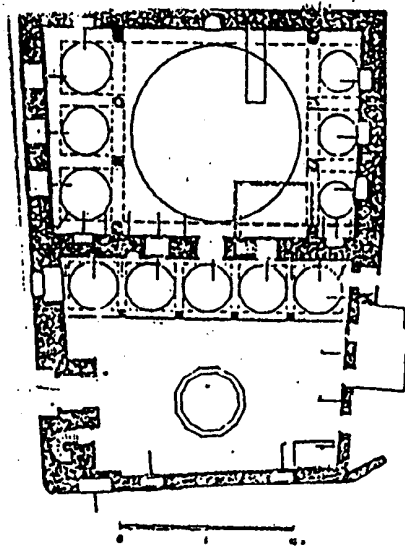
مسقط أفقي لجامع الوالدة العتيق باسكدار
